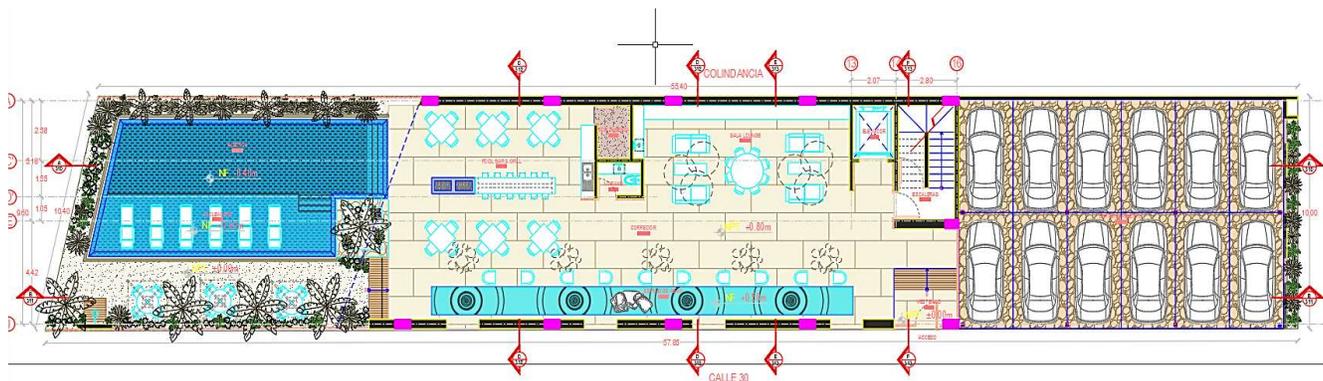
Plano general de obras del proyecto (Más detalles en ANEXO 1).
